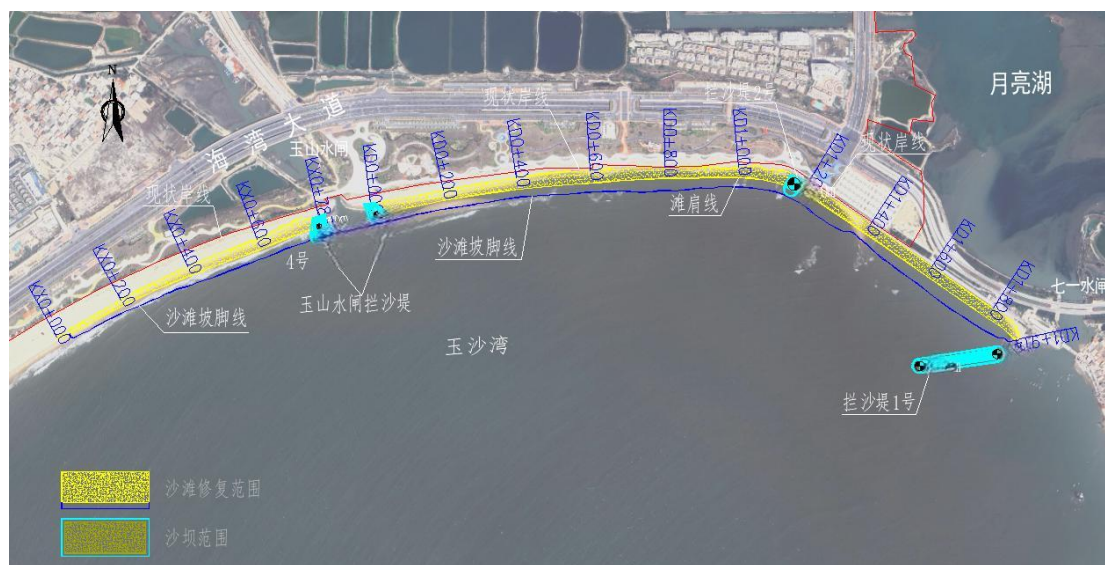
玉沙湾砂质岸线修复平面布置图（方案三）
